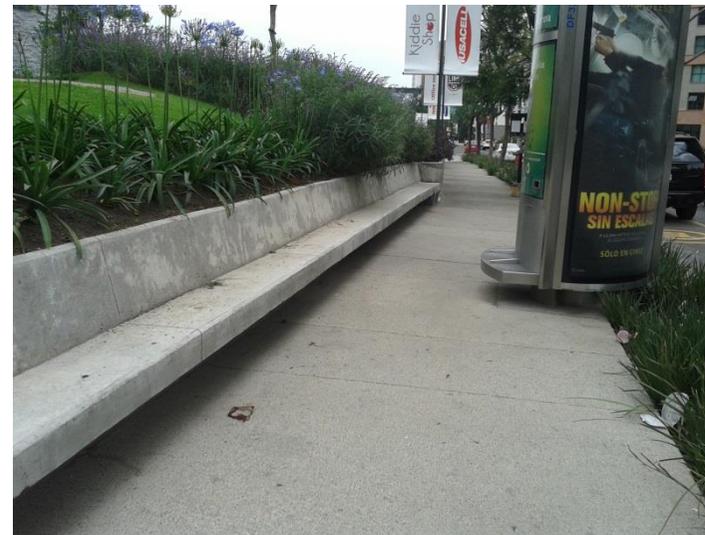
Banqueta perimetral Centro Comercial Garden Santa Fe
